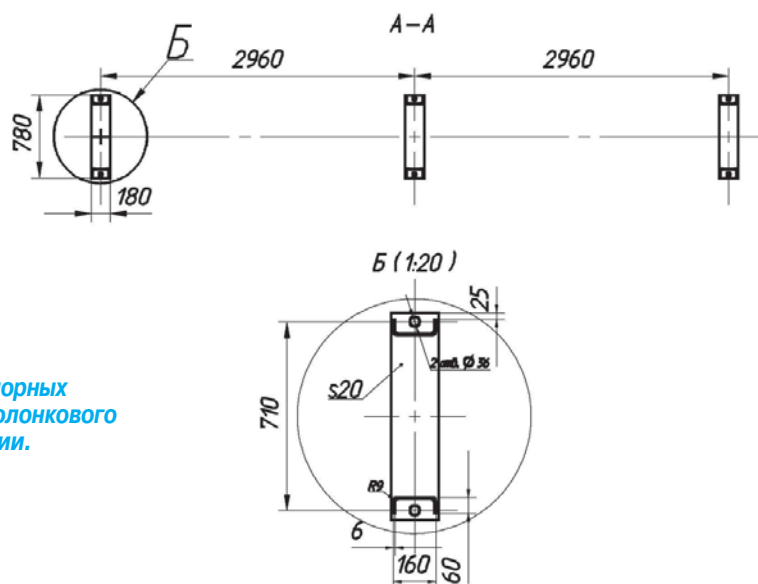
Установочные размеры опорных конструкций выключателя элегазового колонкового ВГТ-1А1-220 в типовом исполнении.
